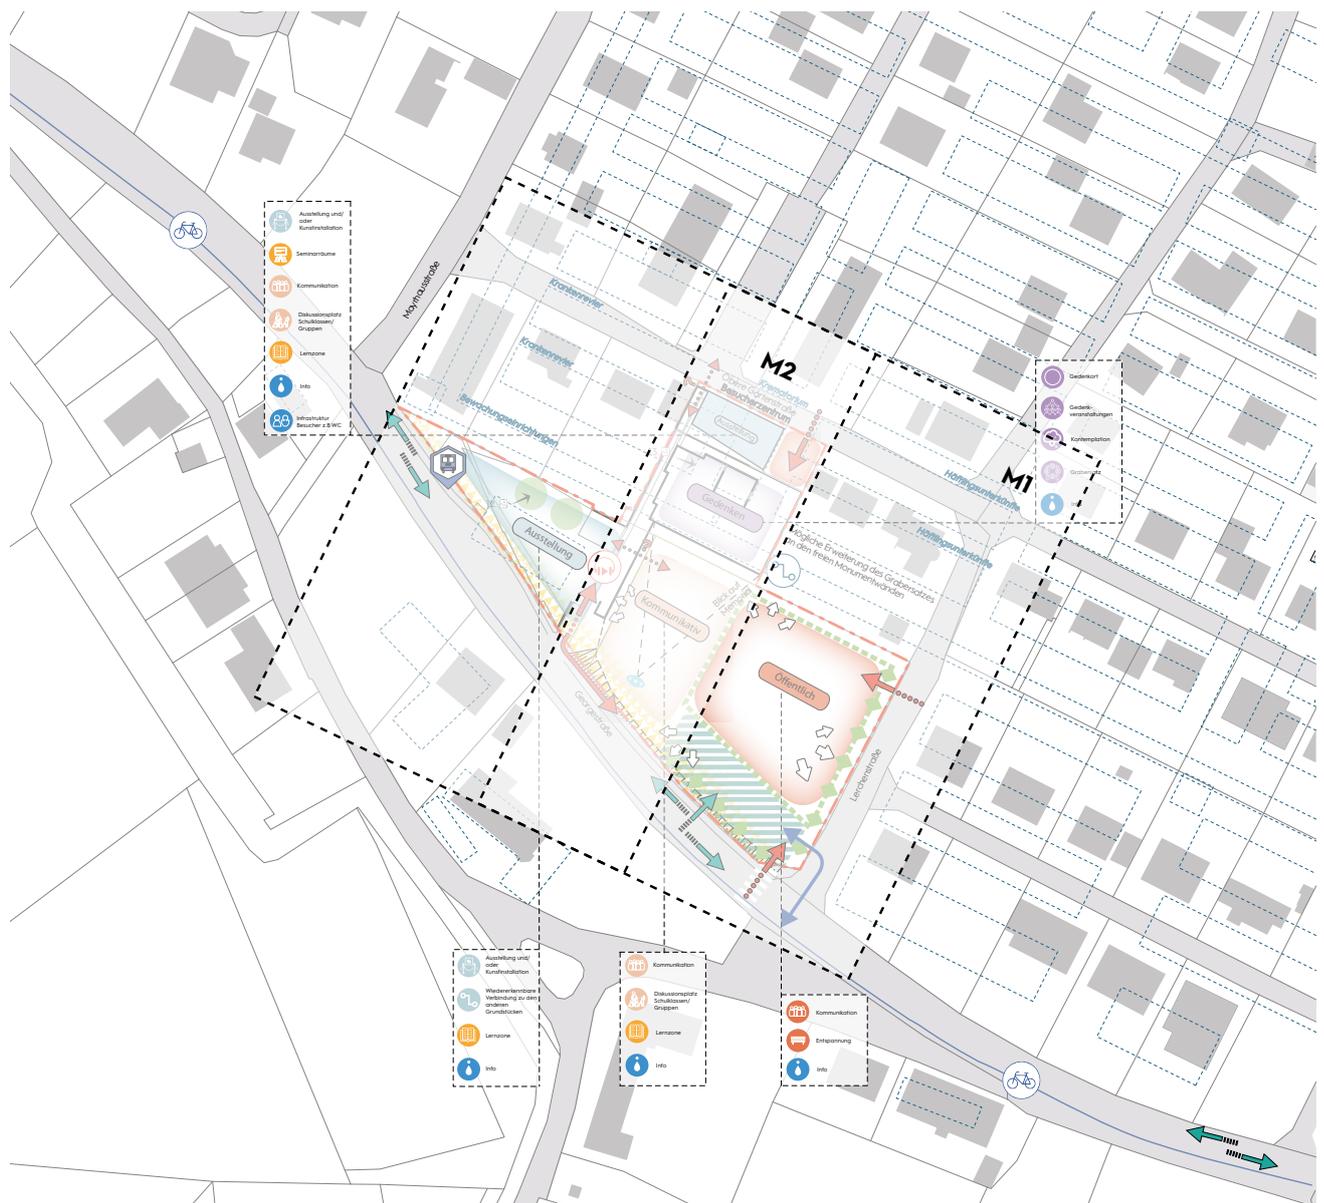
Masterplan Grundriss Memorial (Ausschnitte M1 und M2 werden auf den Folgeseiten dargestellt)
